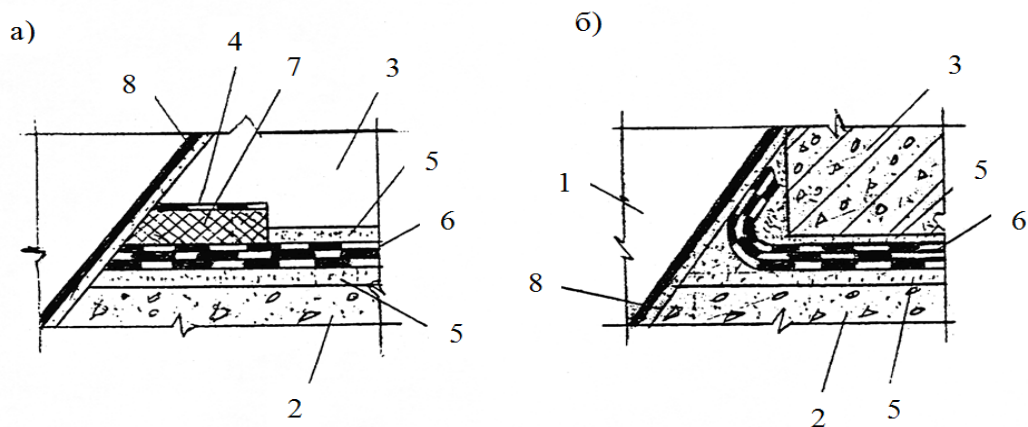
Гидроизоляция реконструируемых подвалов по существующему бетонному полу, при уровне грунтовых вод более 50 см (вариант армирования сварными сетками)
